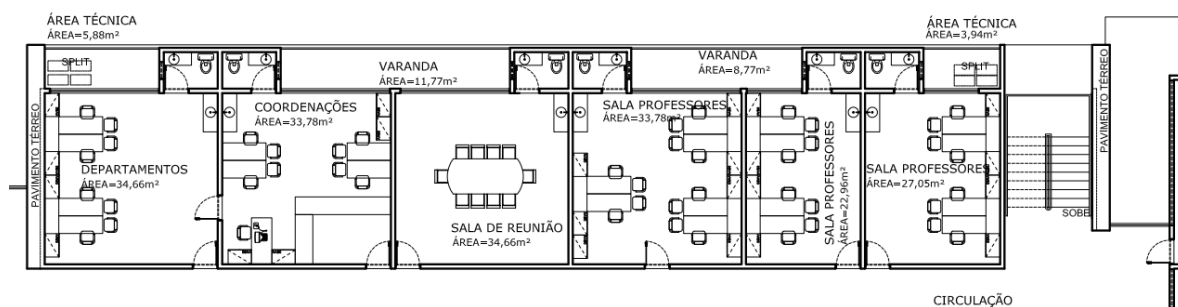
Salas dos Professores - 2º Pavimento Bloco 02 - Fachada e Planta Baixa
